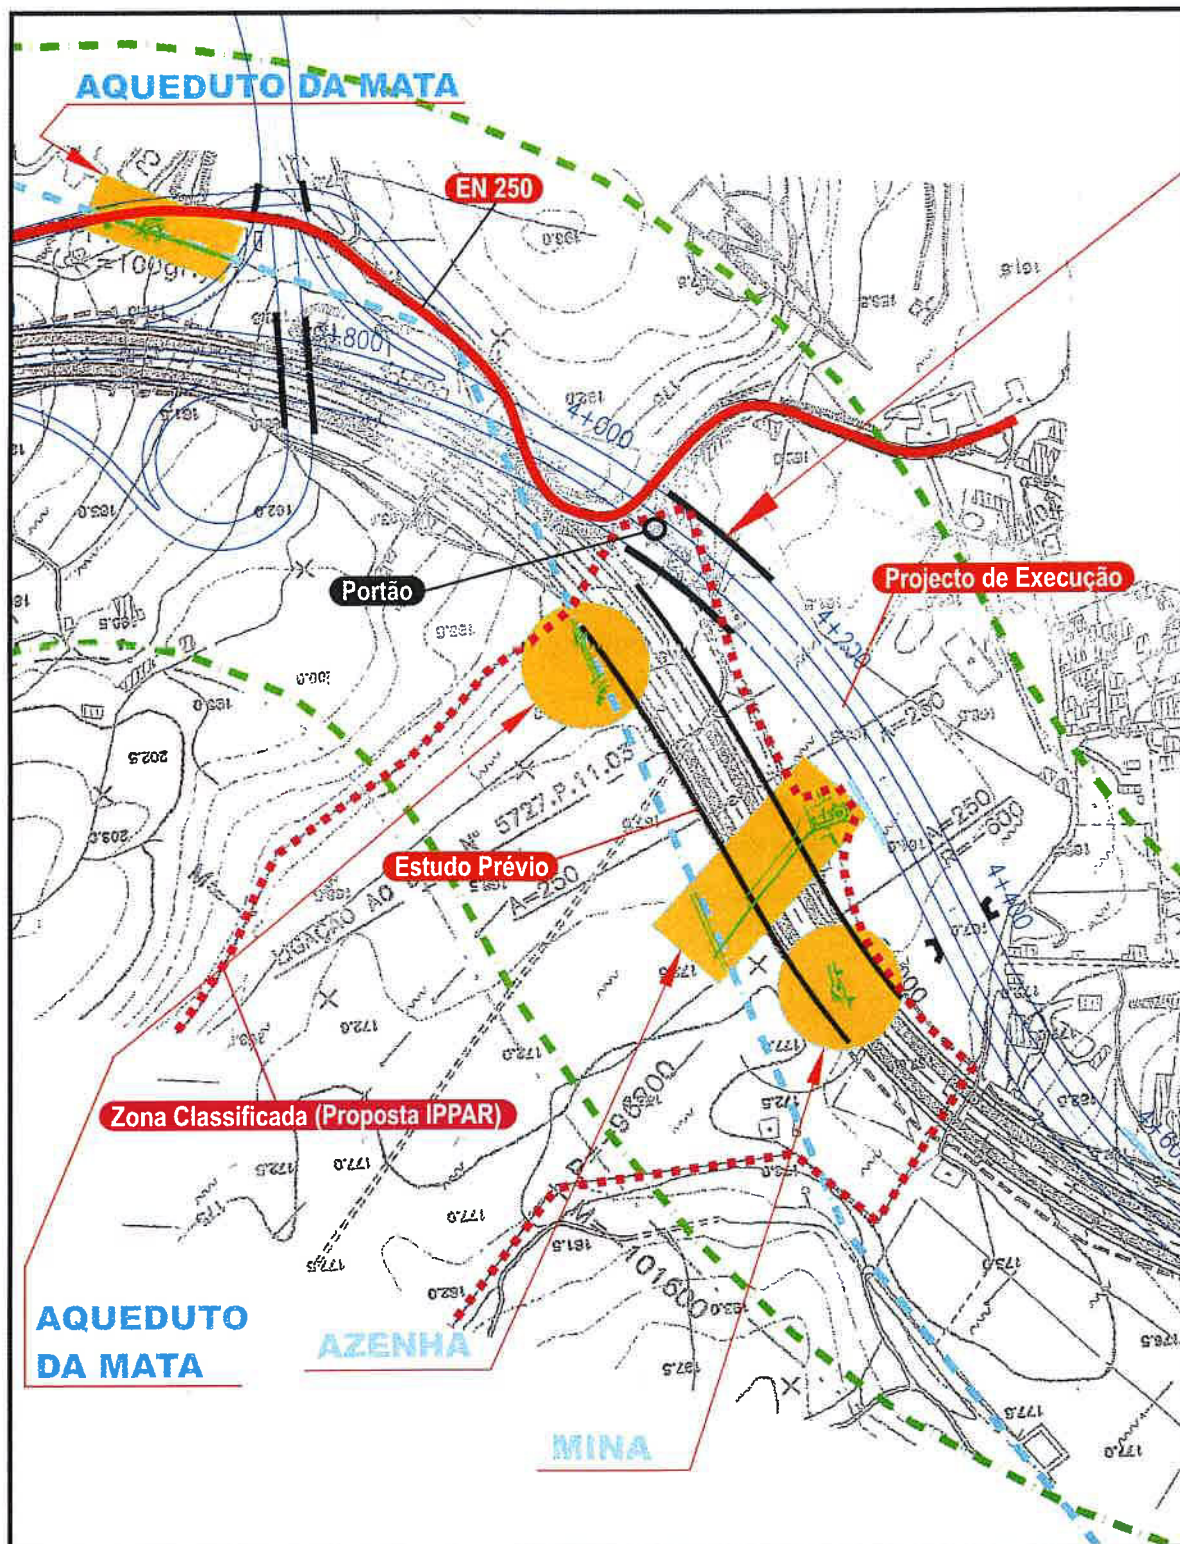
Alteração de Traçado na Zona da Quinta do Molhapão
